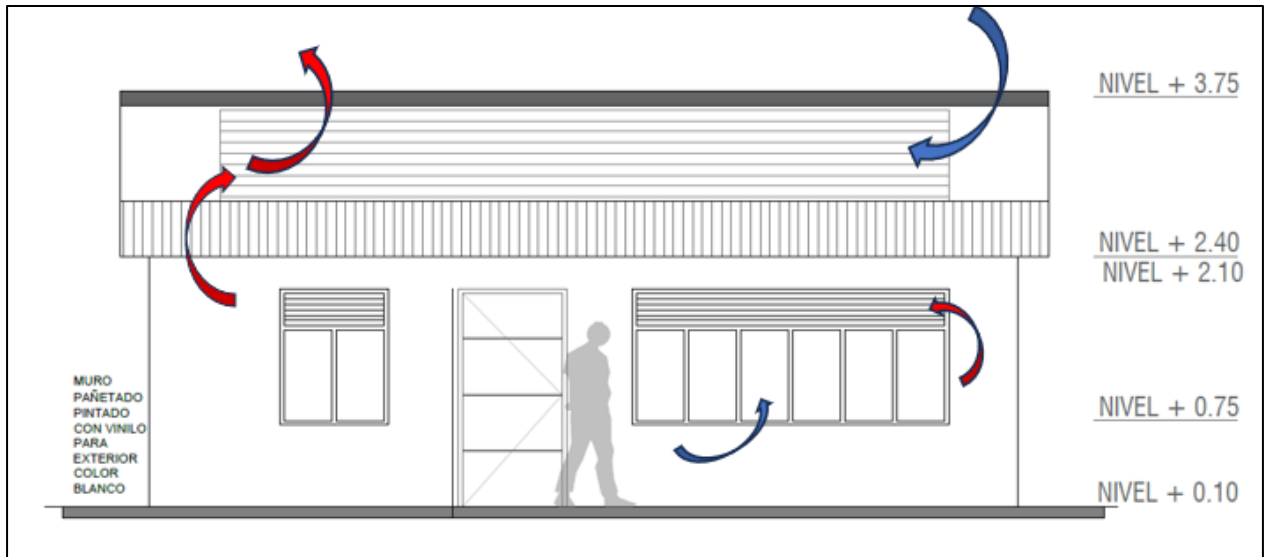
Fachada principal. Fuente: Autores, 2024.
